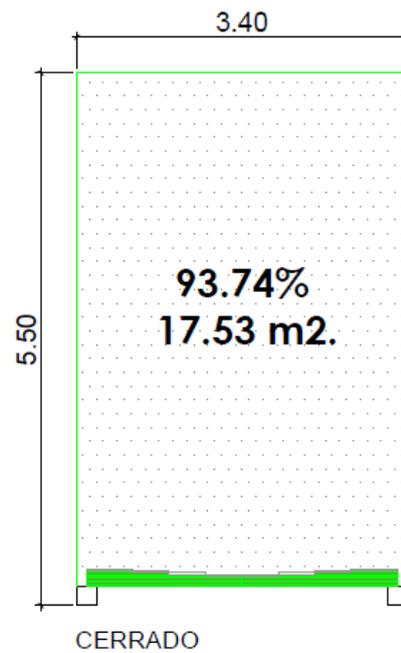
Vista en planta de la superficie del garaje puerta cerrada.
